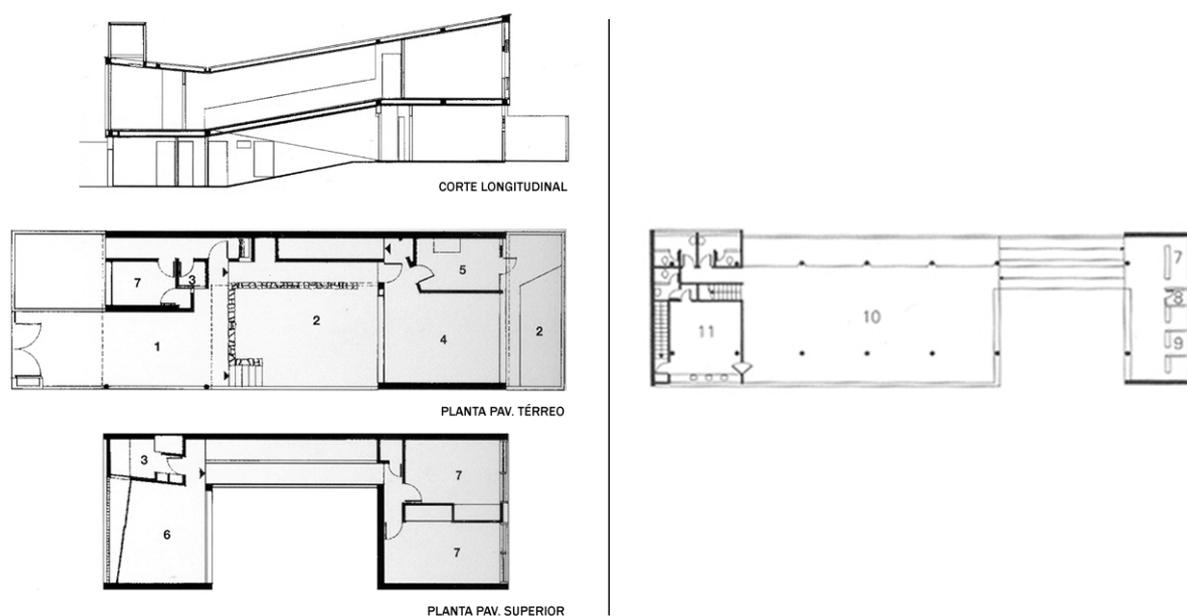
Residência D'Estefani em São Paulo 1949 e Planta 1º pavimento da Rodoviária de Londrina 1950. Vilanova Artigas.
